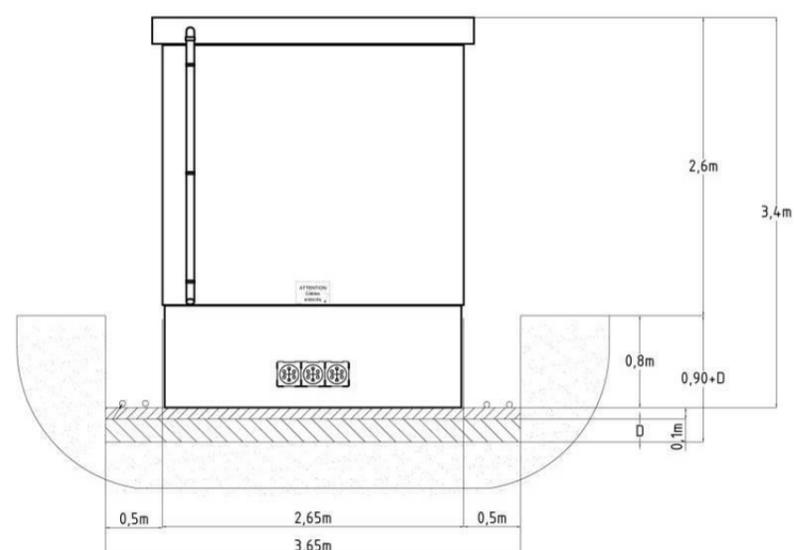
Plan de façade d'un poste de livraison (vue de profil)
